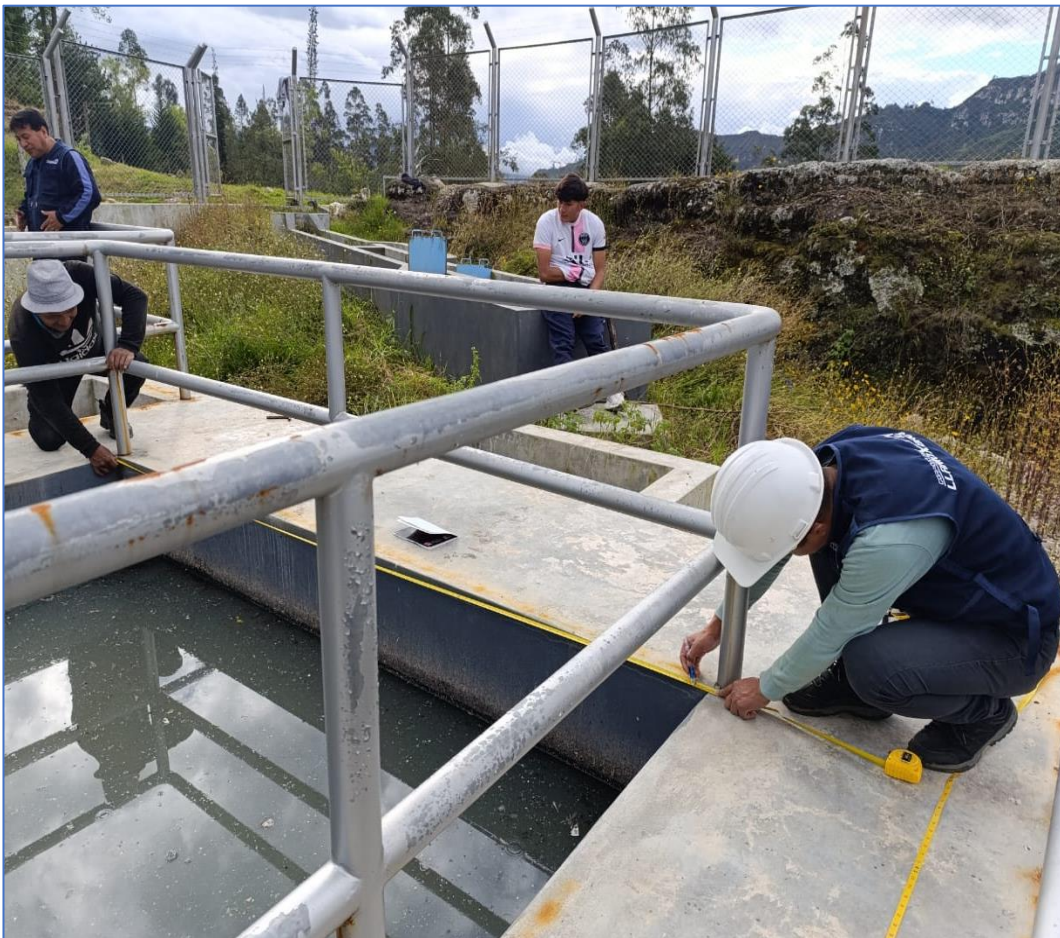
Presencia de grietas en las paredes o muros del tanque Imhoff
